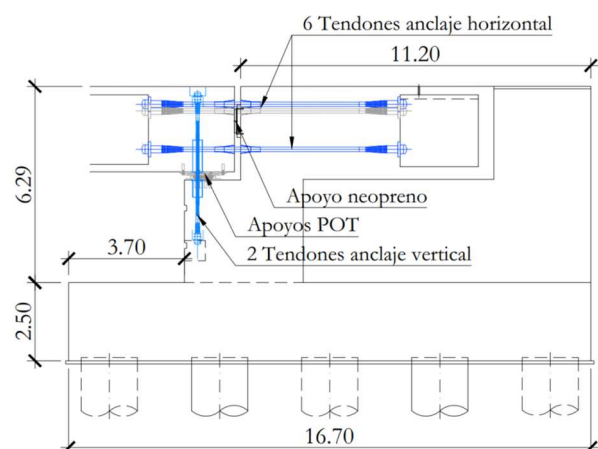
Sección longitudinal del estribo 2, punto fijo del tablero. Anclajes horizontales y verticales.
